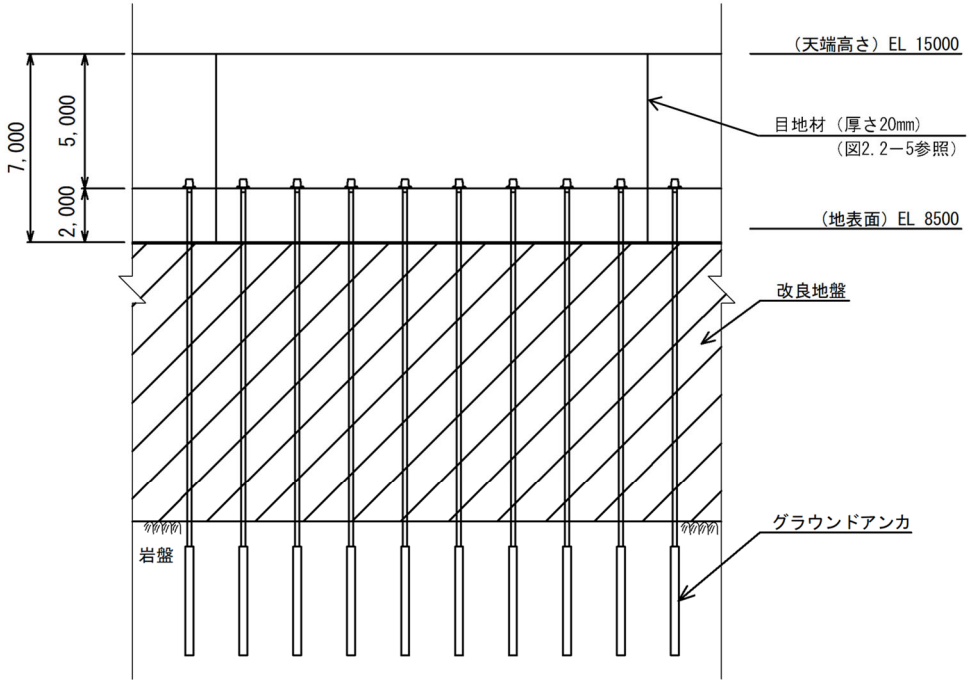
防波壁（逆 T 擁壁）の構造図（正面図）
